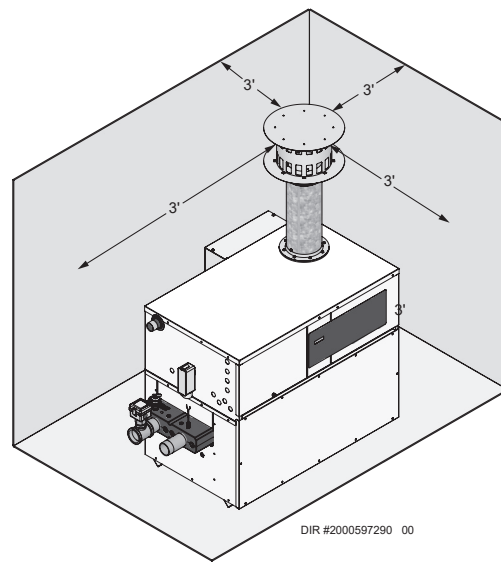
Cheminée des conduits d'évacuation installée sur les modèles 987 - 2067
